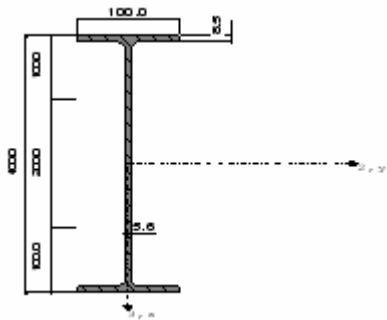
Schweißprofil 1/2 IPE mit eingeschweißtem Steg
